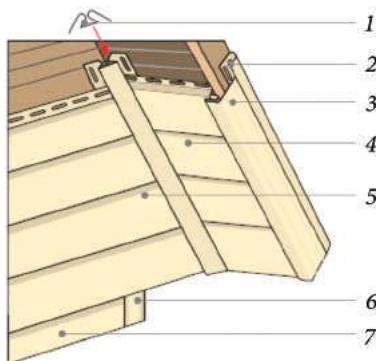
Установка сайдинга на фронтон: 1 — профиль внутреннего угла; 2 — финишная планка; 3 — J-профиль; 4 — обшивка свеса крыши рядовым сайдингом или панелями софитов; 5 — обшивка свеса крыши рядовым сайдингом; 6 — профиль внешнего угла; 7 — обшивка стены рядовым сайдингом
